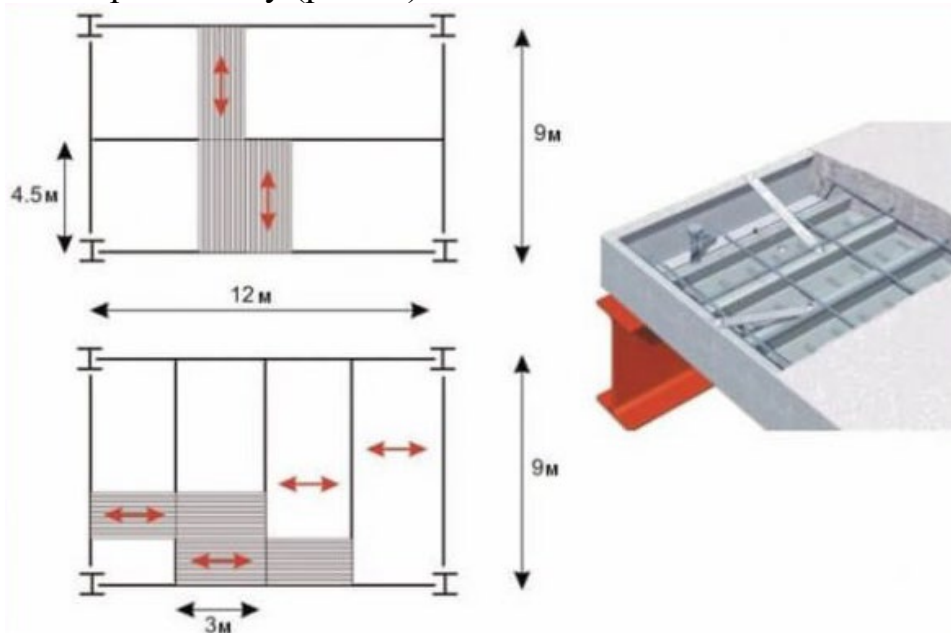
Схема напрямків укладання профільованого настилу в прольотах перекриття та конструктивне рішення монолітного перекриття з профнастилом [5]
